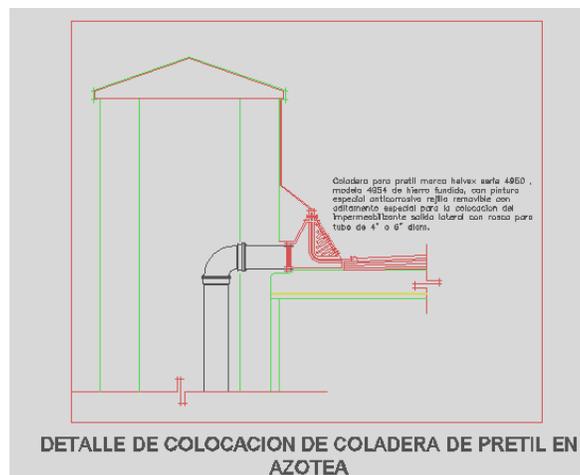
Detalle de colocación de coladera de pretil en azotea.
